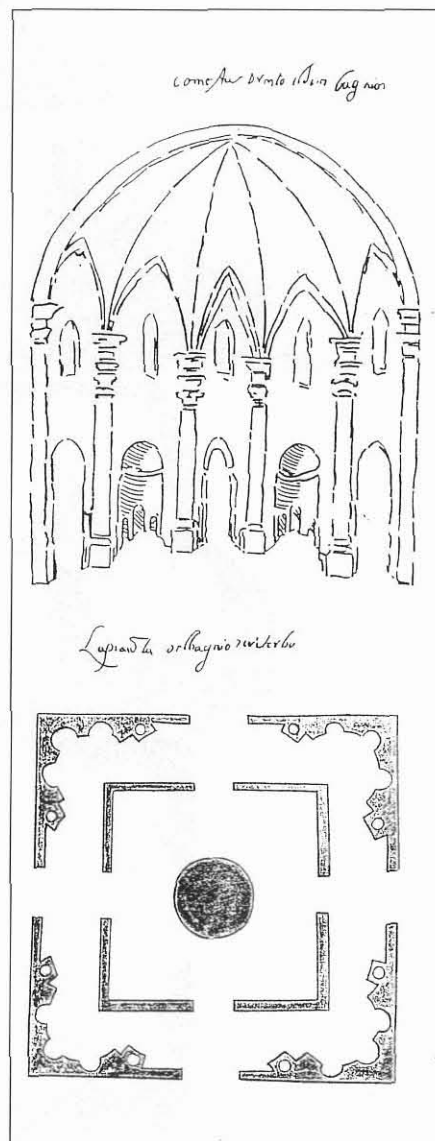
Terme del Bacucco. Pianta e spaccato di Michelangelo
